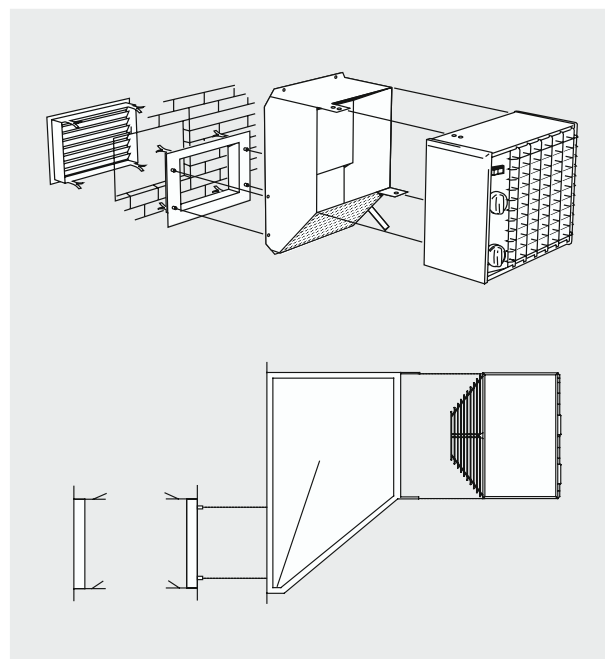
Общий вид и поперечный разрез при установке тепловентилятора Cat с камерой смешения.
